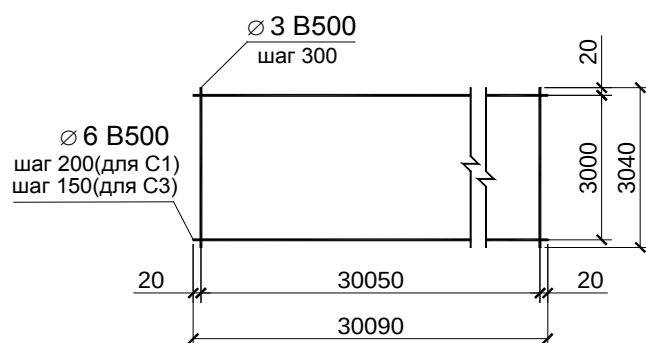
Армирование плиты сварными сетками с поперечным расположением рабочих стержней (вариант II)
